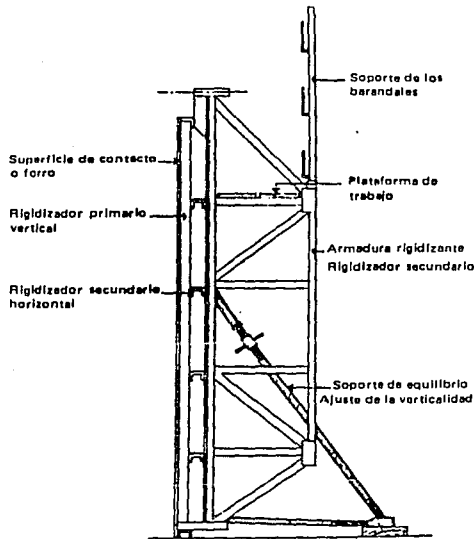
Partes Constitutivas de una Cimbra para Muro.
